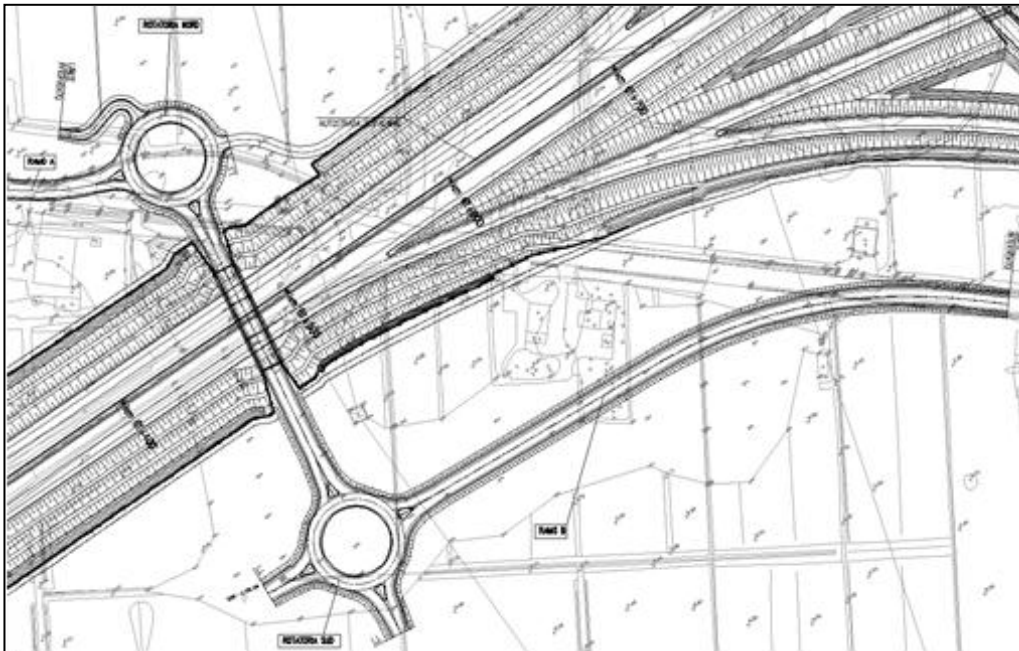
SCHEMA PLANIMETRICO DELLA INTERFERENZA
